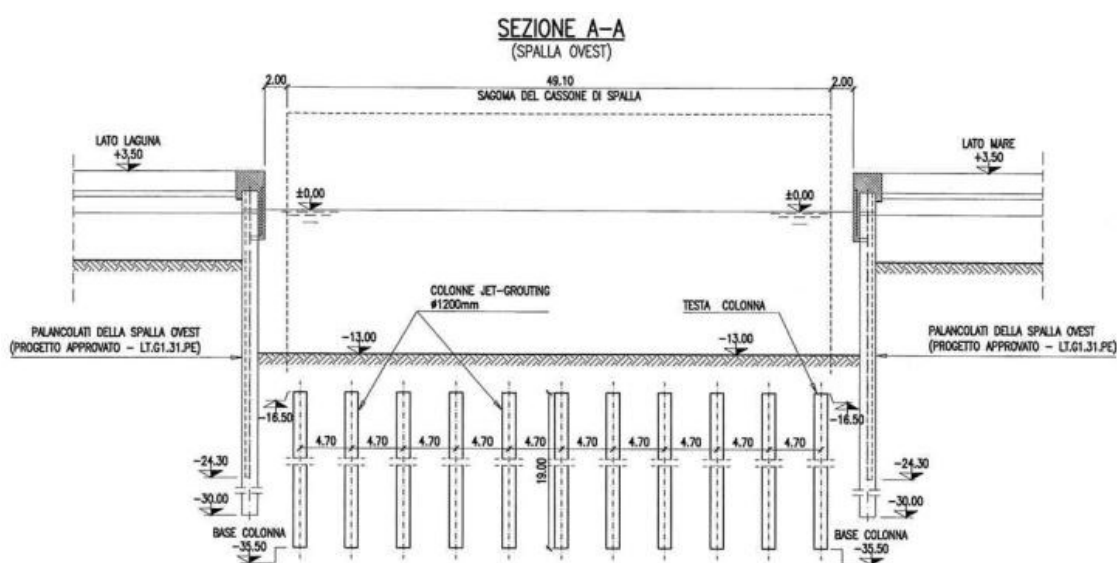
Schema jet grouting per il cassone di spalla Ovest; estratto dagli elaborati grafici AS BUILT.
